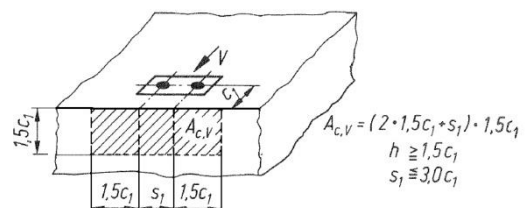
Projizierte Fläche einer Zweifachbefestigung unter Querlast [Eligehausen, Mallée (2000)]
